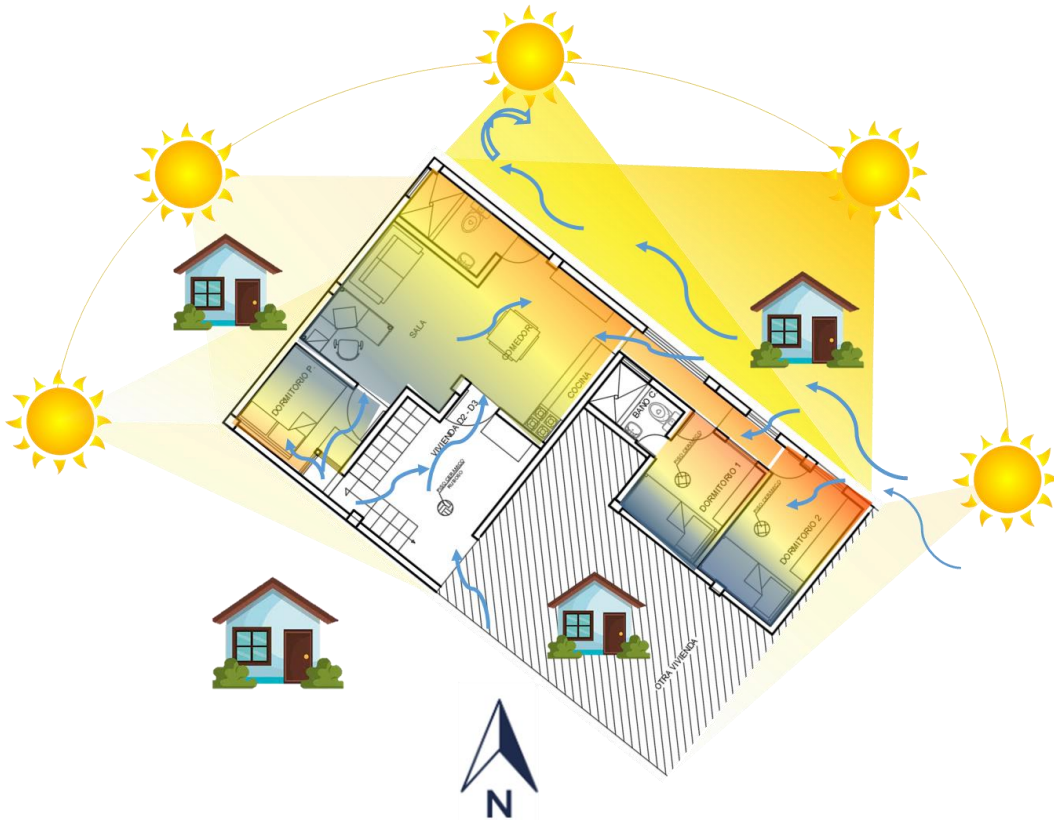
Plano de la vivienda DB – Nivel 3er piso
